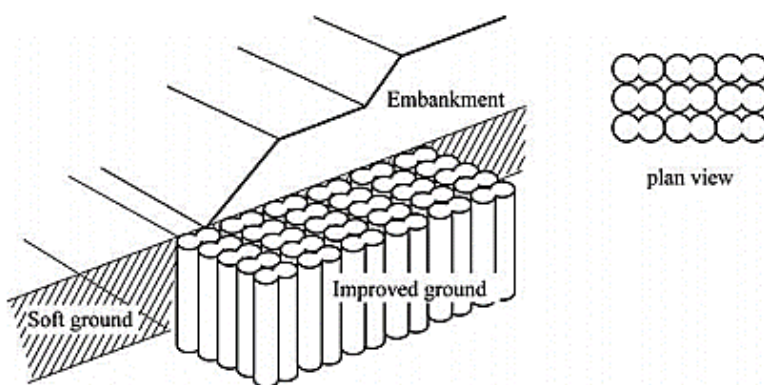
Grupos de columnas en configuración de bloques tangentes. (Fuente: Ref. [1]).
